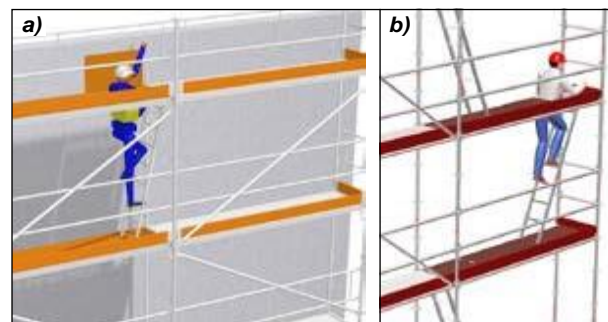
a) detalle de acceso mediante escalera, plataforma y trampilla lateral y b) trampilla de apertura frontal.
